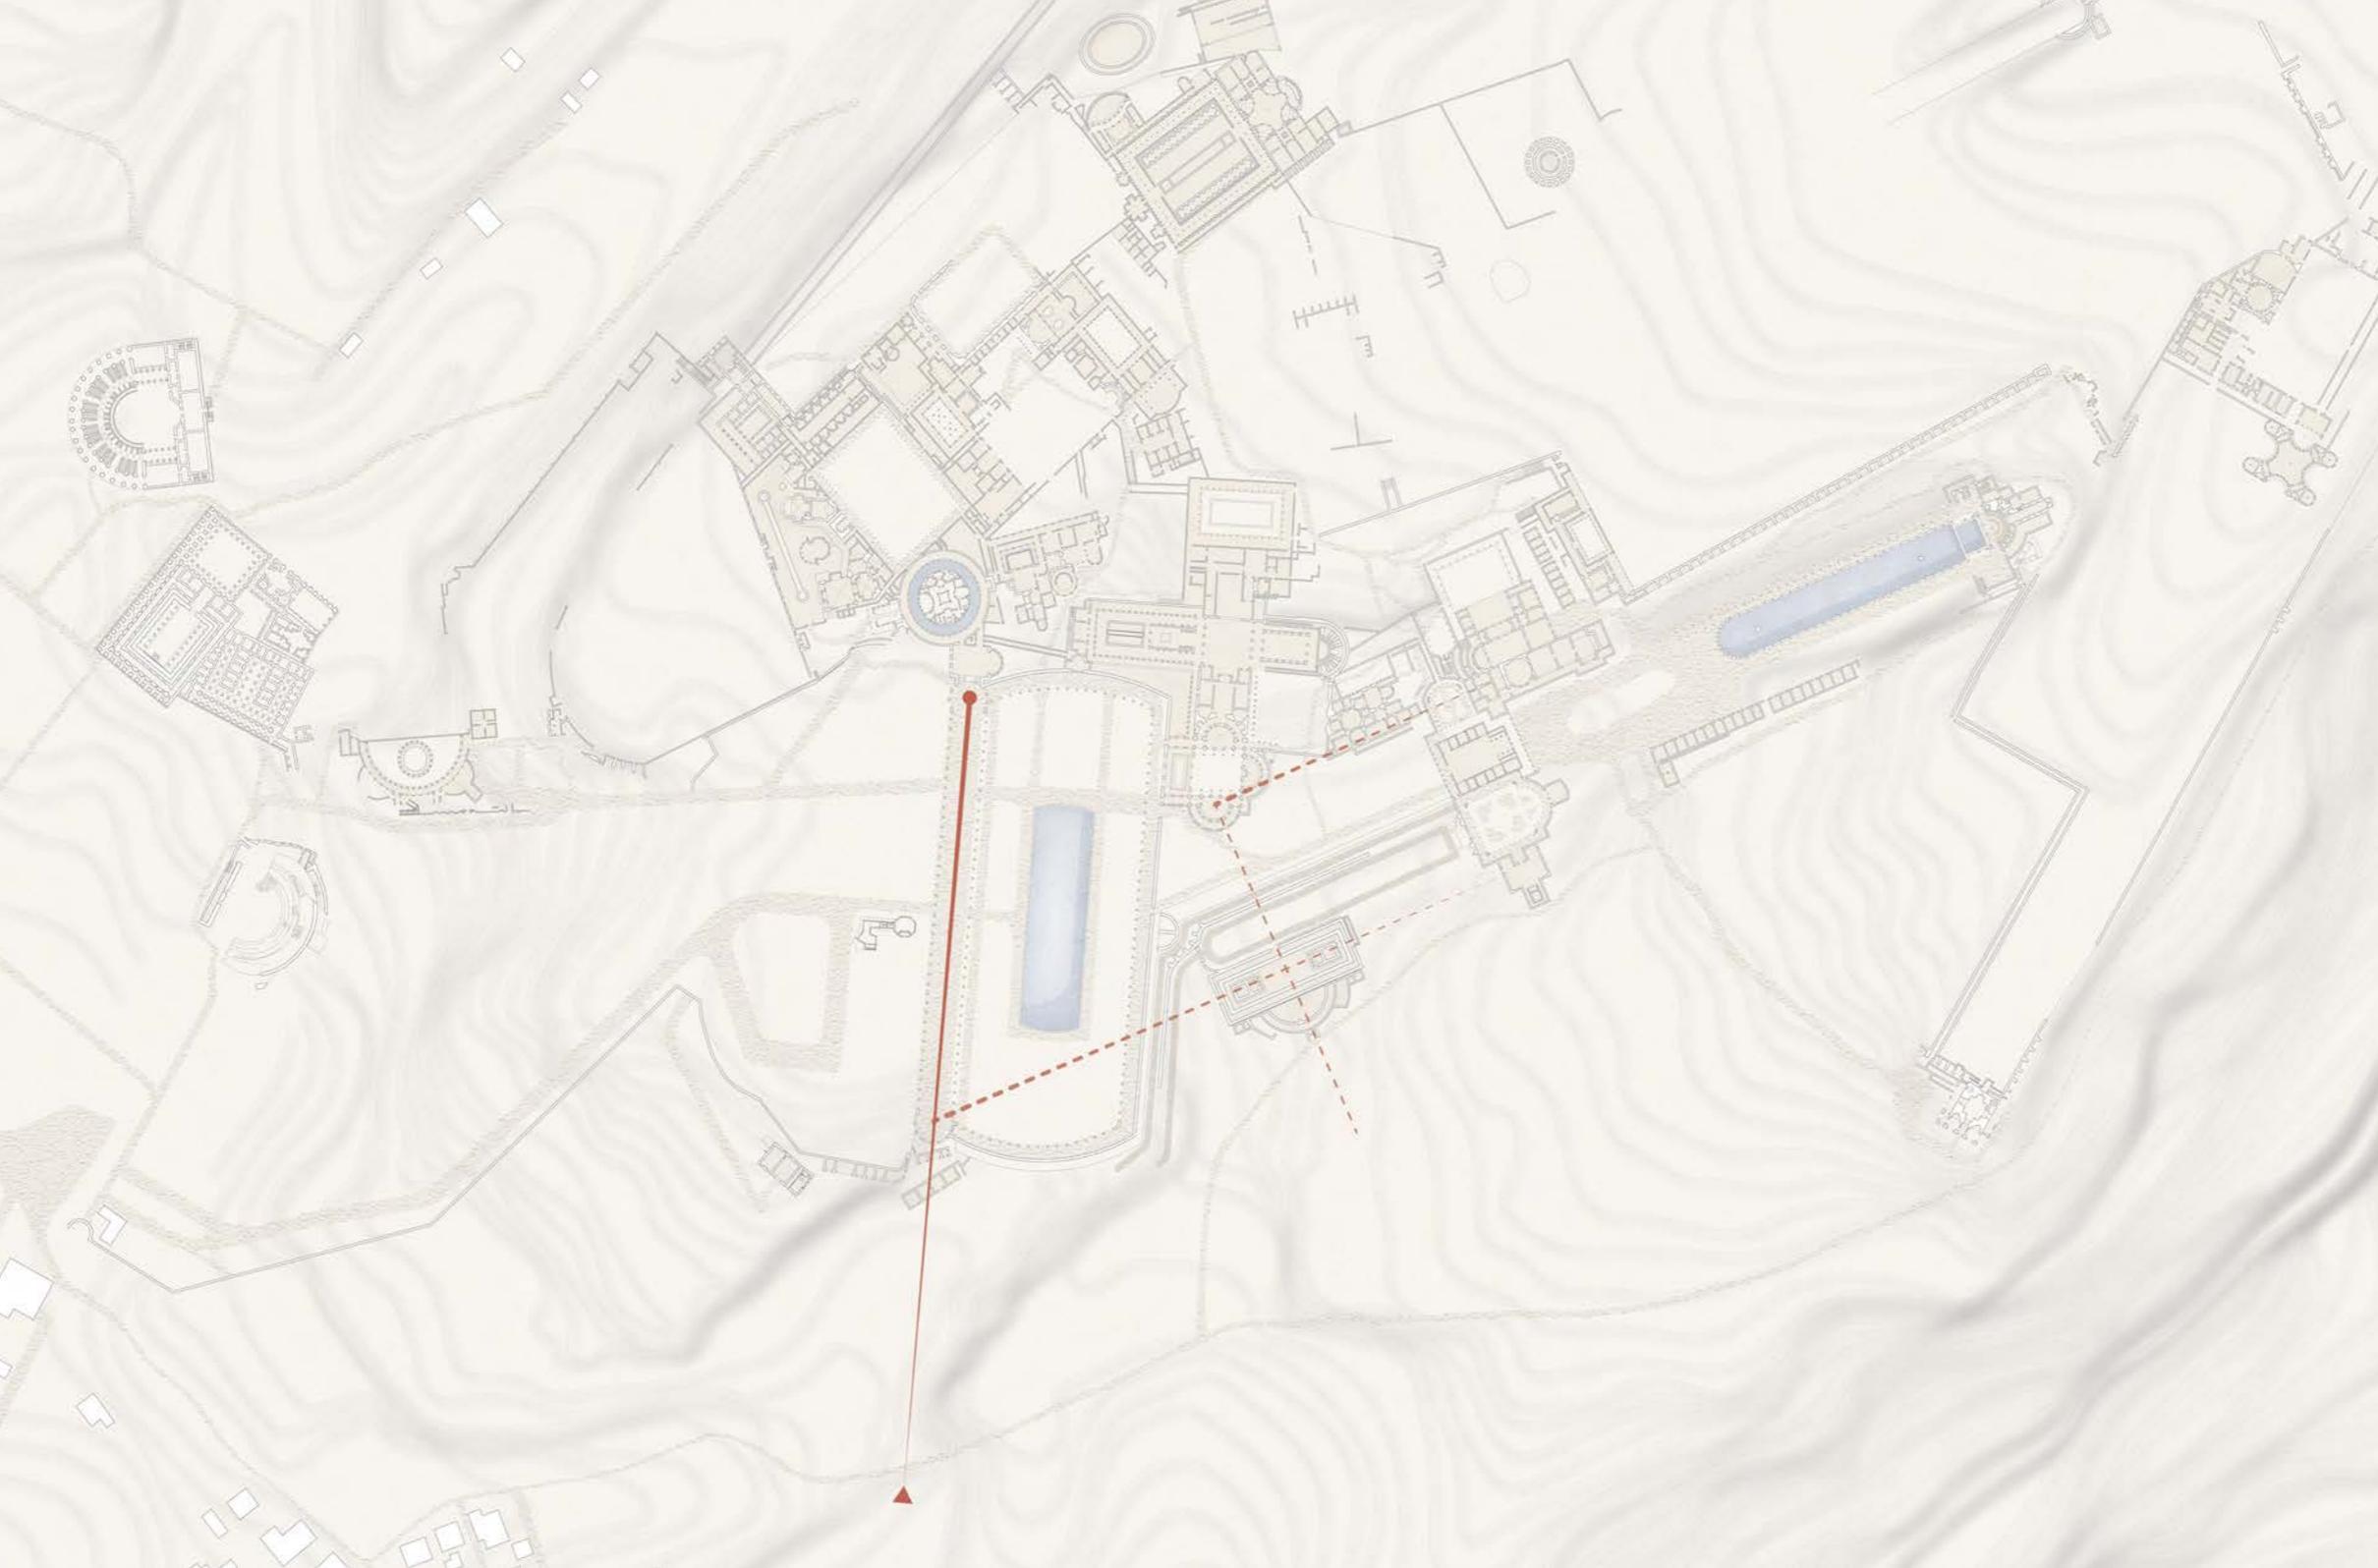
(a sx) - Concept di progetto: la direttrice derivante dalla proiezione a terra del muro del Pecile.
